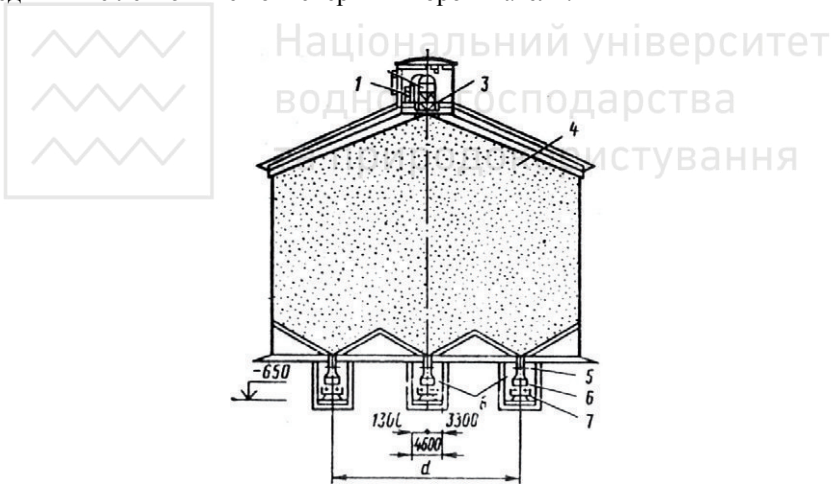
Стальной силос-резервуар с пневматической подачей и выдачей материала:
